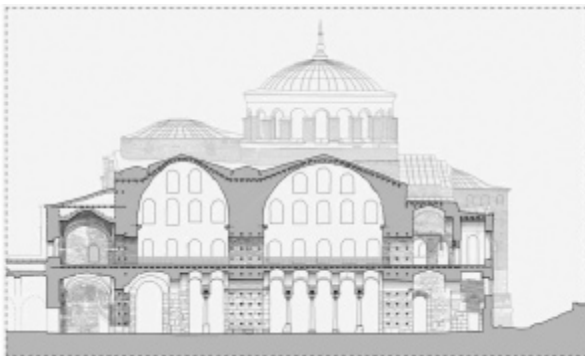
Sezione trasversale dove sono stati indicati gli interventi a livello della galleria e del tetto. Sono stati indicati anche i rinforzi dei pilastri.
